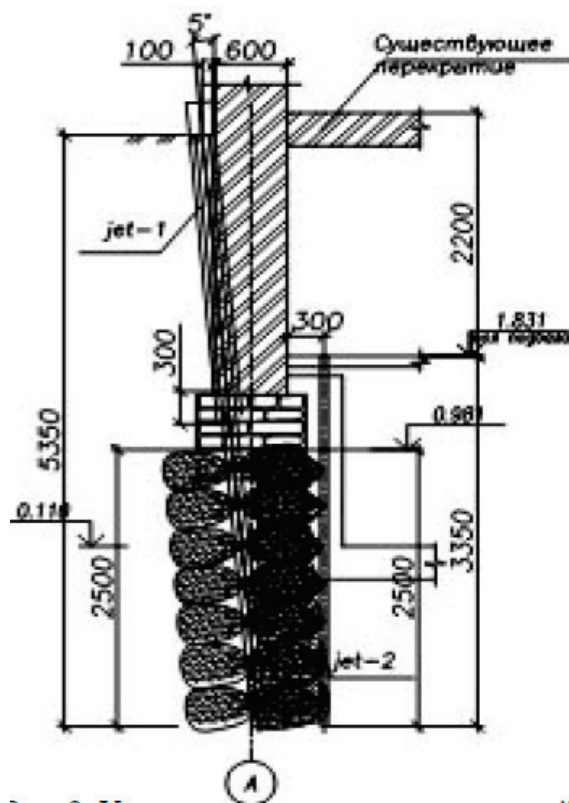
Схема усиления основания под подошвой фундаментов методом jet grouting
